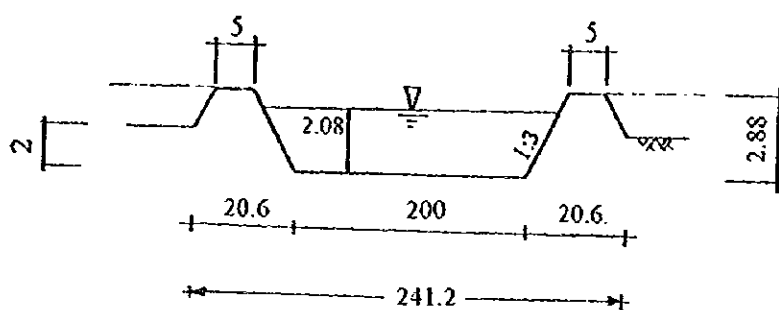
Plan de Encausamiento del Río Jiboa
